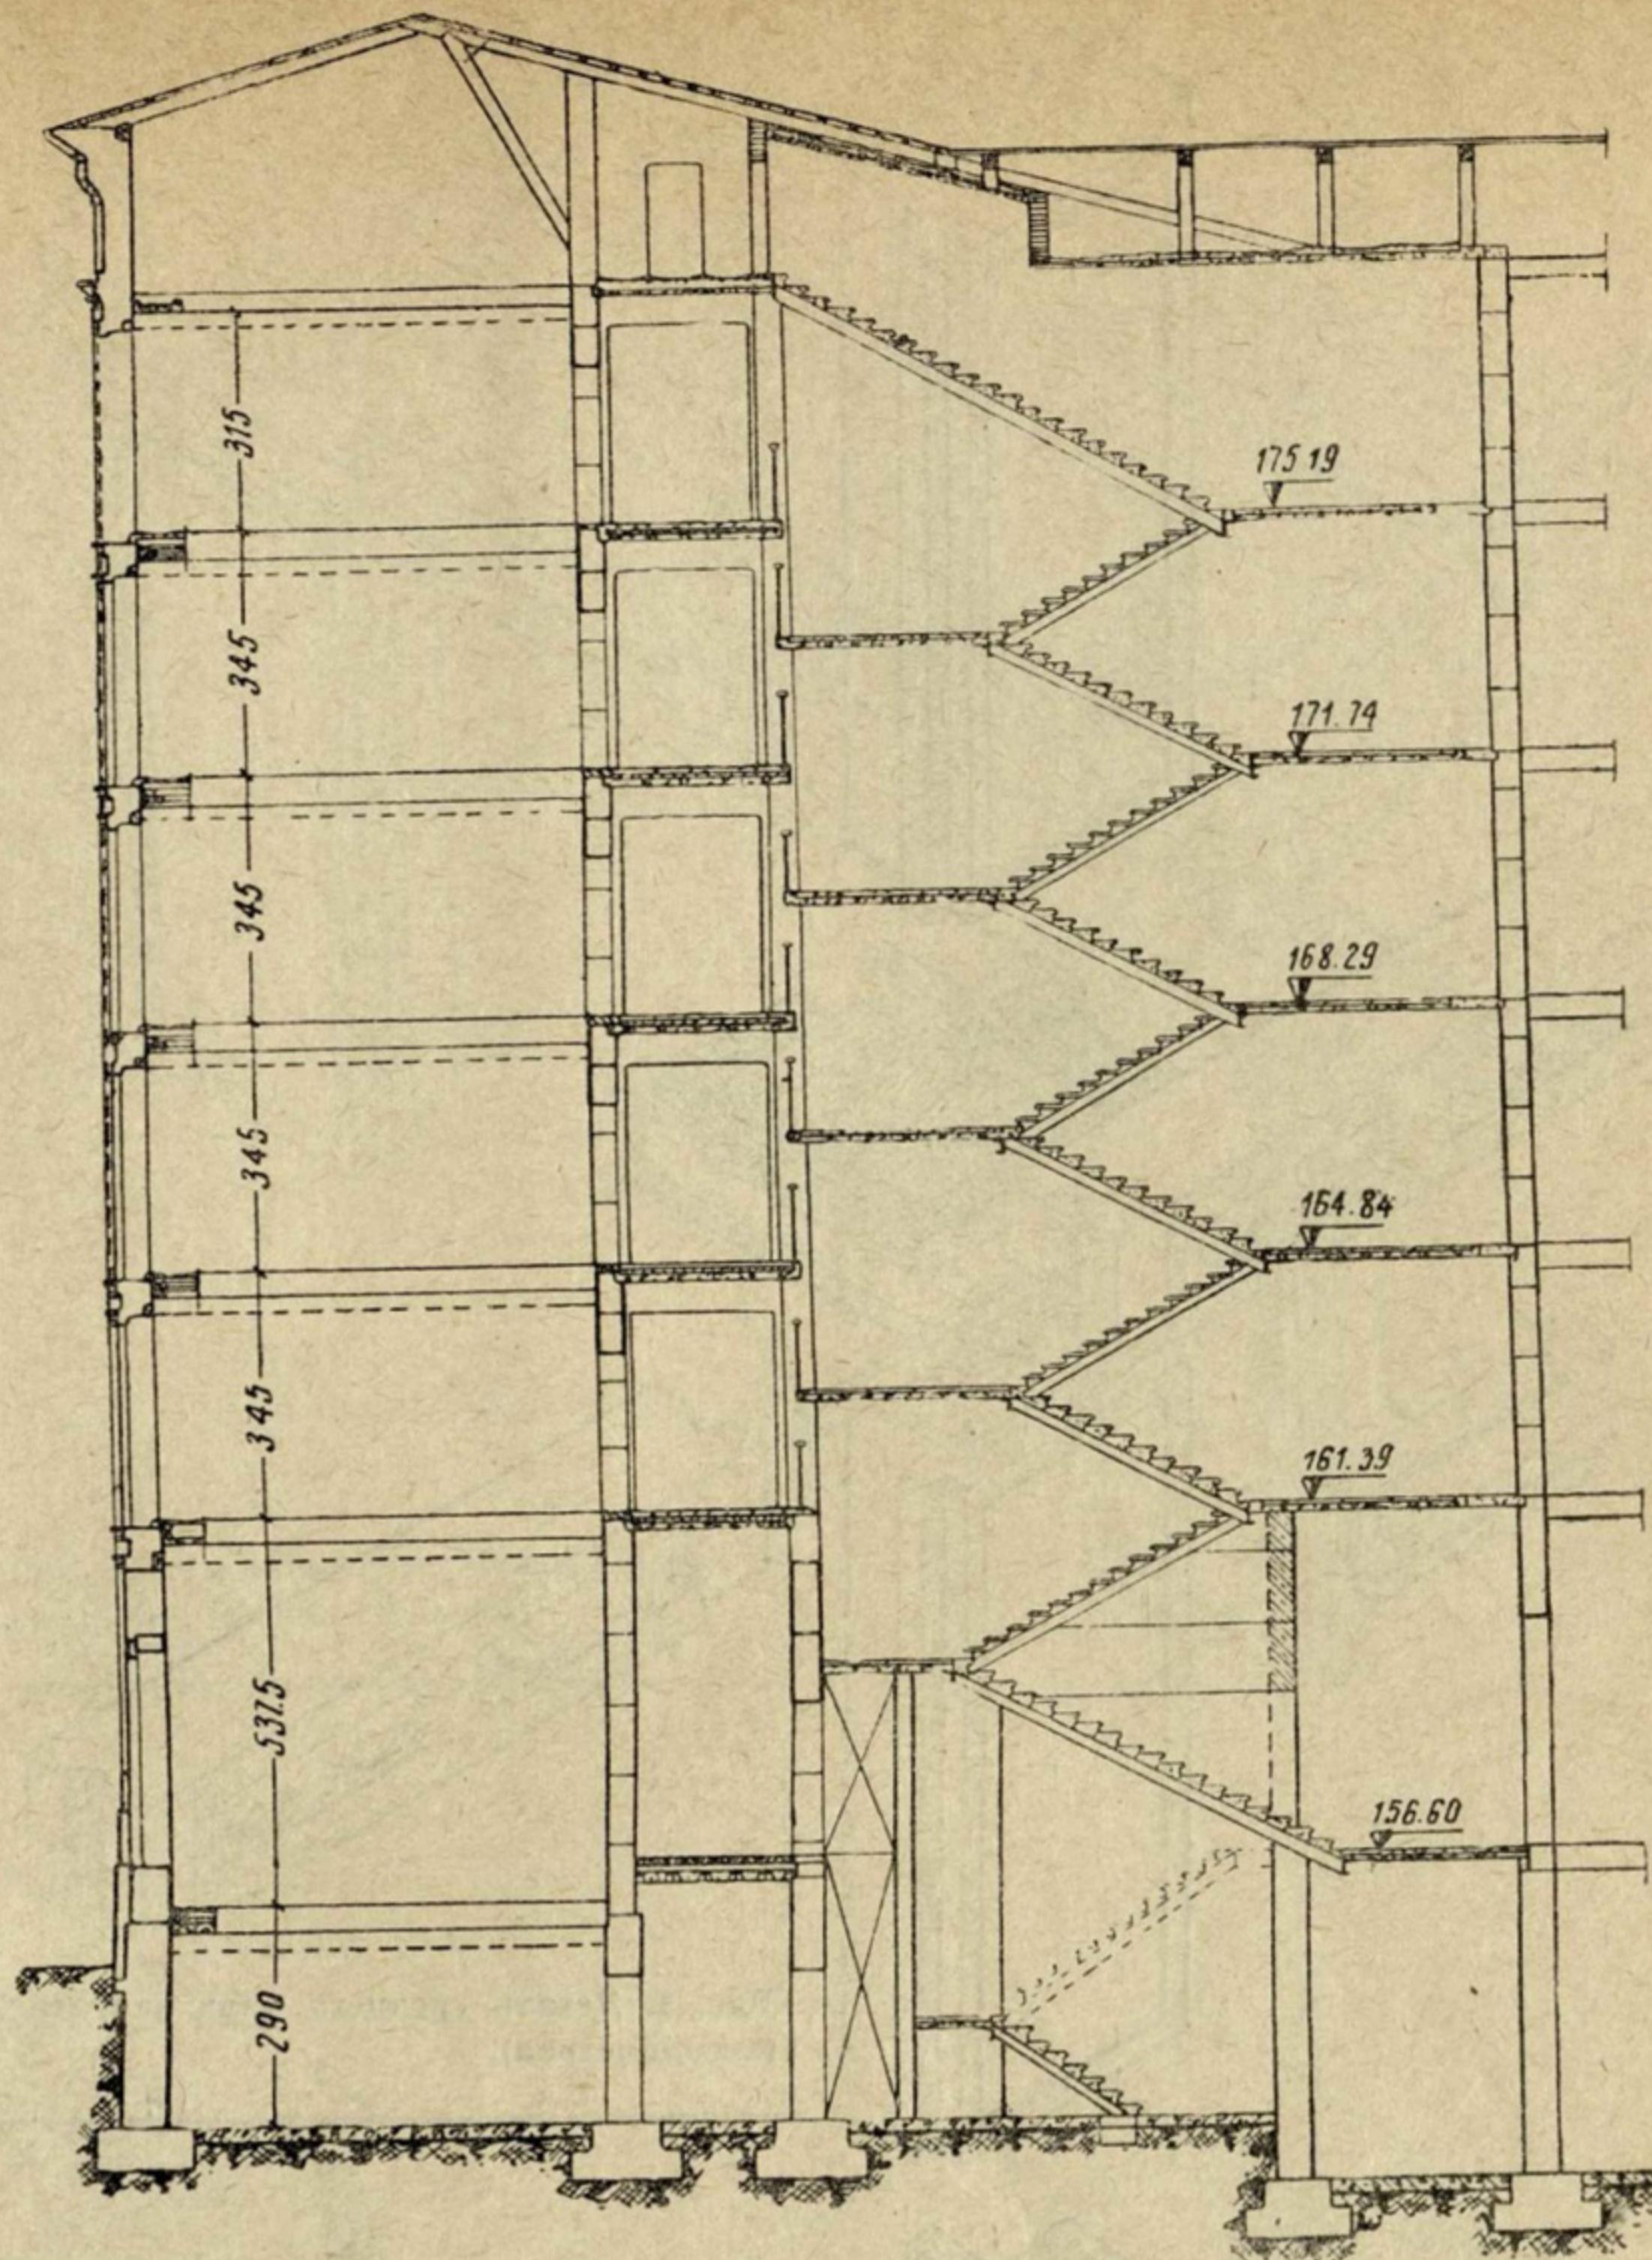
Вертикальный разрез здания по лестничной клетке.
